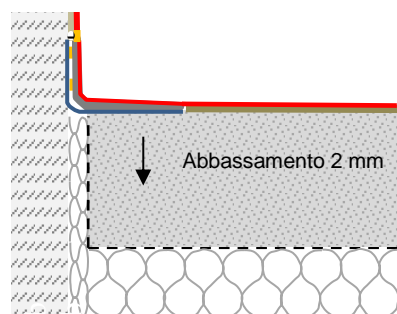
Impermeabilizzazione dell'angolo in caso di un collegamento fisso tra la copertura in calcestruzzo e la parete in calcestruzzo.
